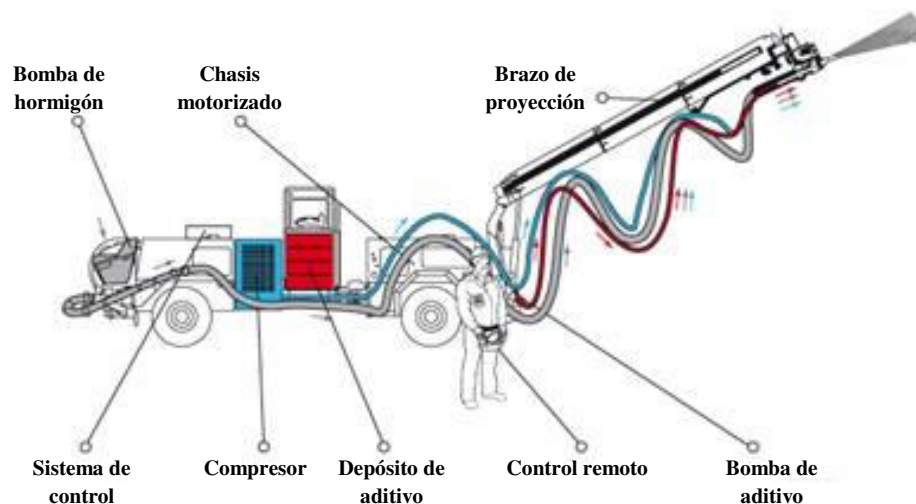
Equipo robotizado para colocación de CLRF. Fuente: (bestsupportunderground.com)
